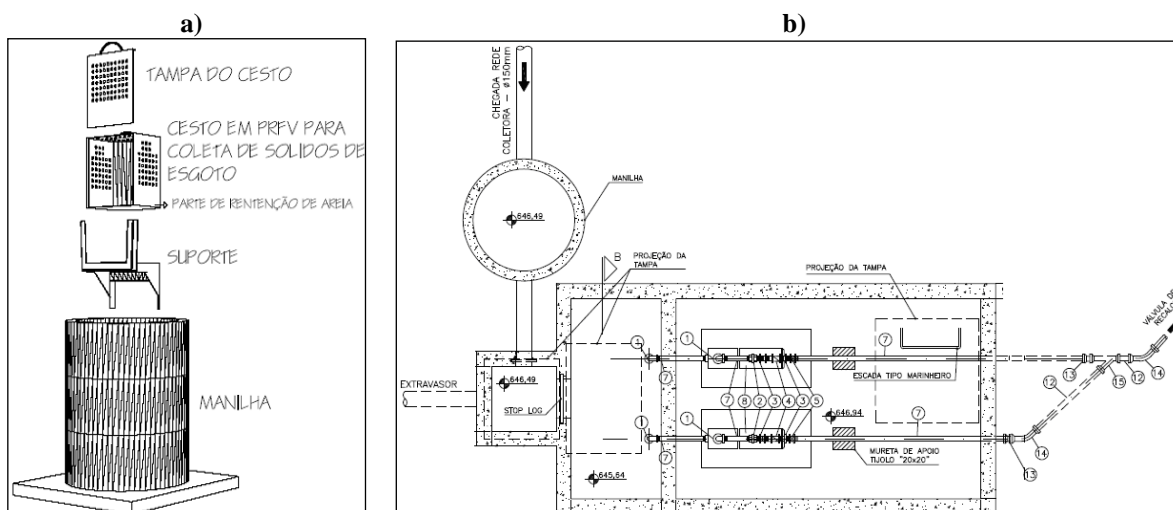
Cesto Móvel com Tampa e o Posicionamento do PV na Elevatória em planta baixa.
